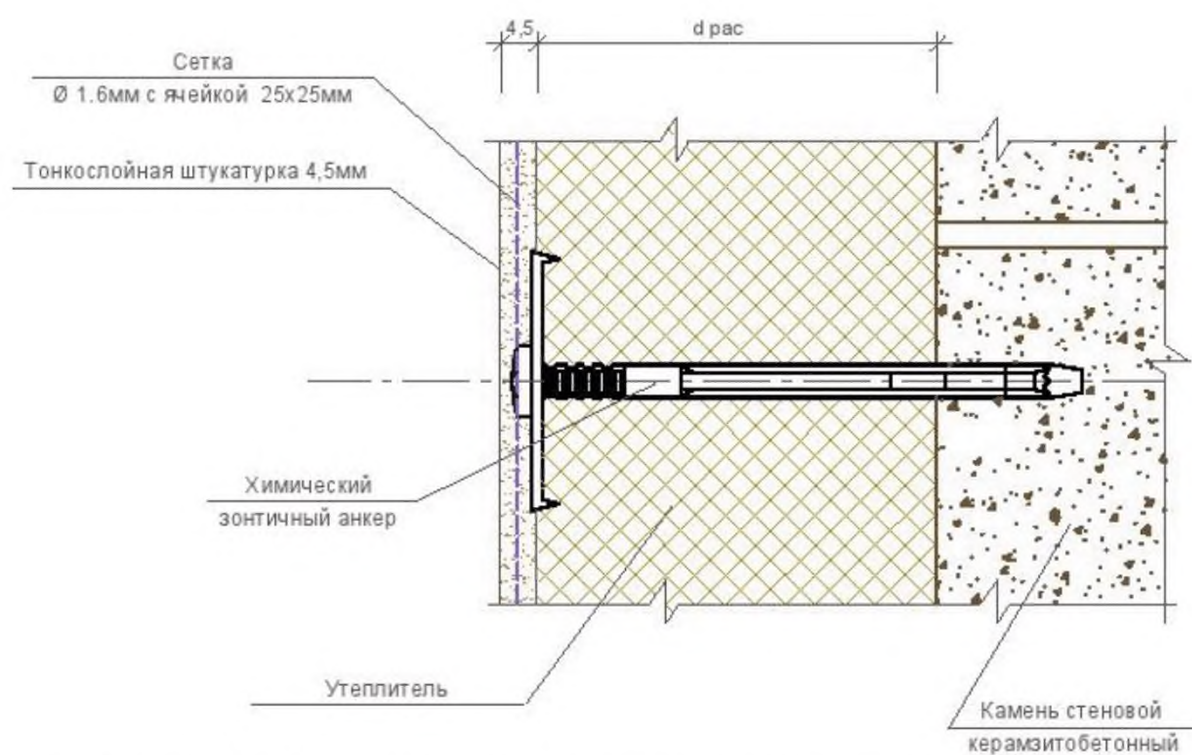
Фрагмент облицовки утепляющего слоя стены
